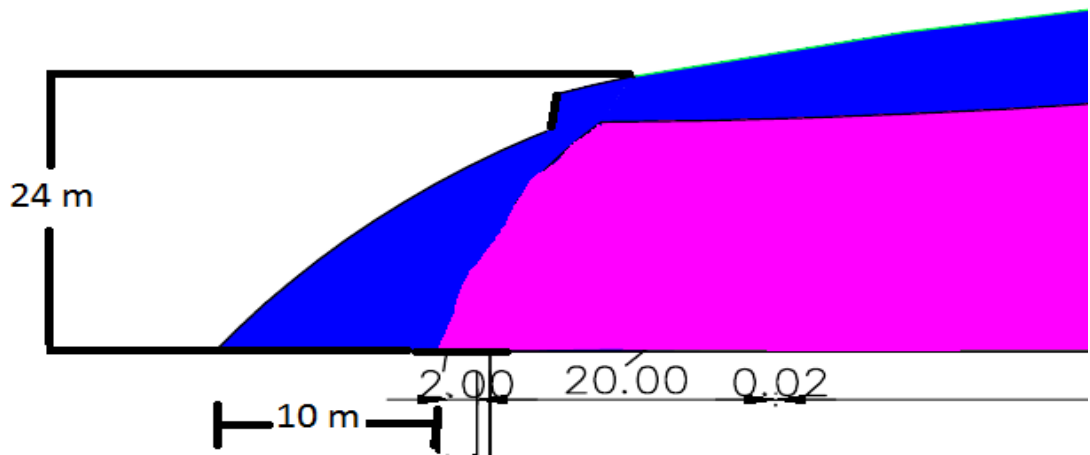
L'entrée ouest du tunnel avant l'excavation
